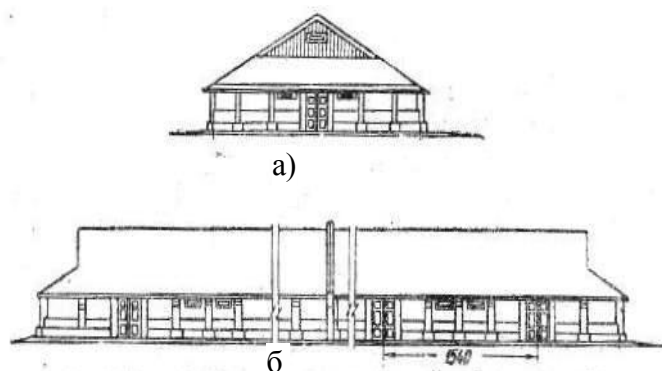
Двосекційний зерносклад типу 1953 р із стінами з вогнестійких матеріалів : а) поперечний та б) – повздовжній перетини.
